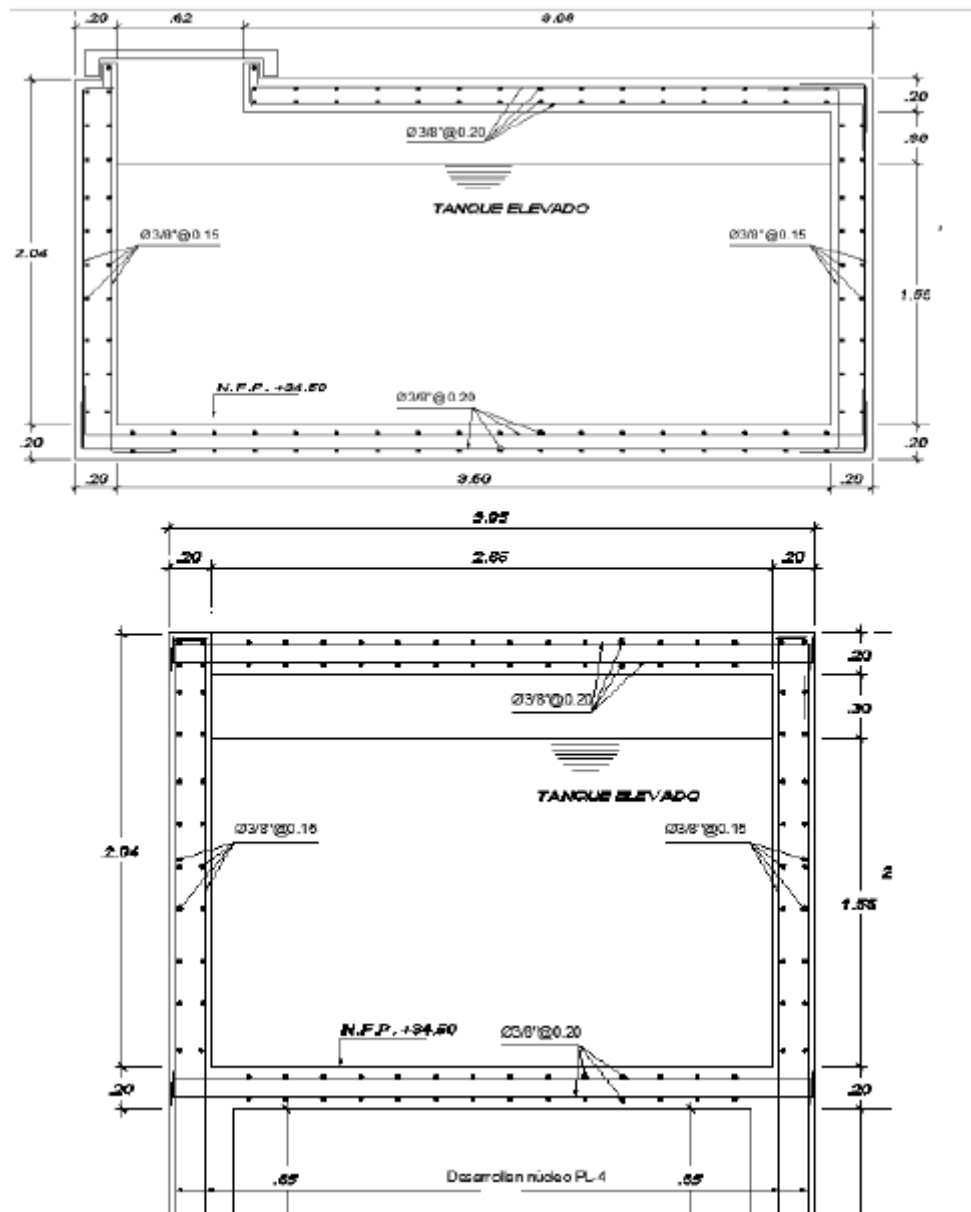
Detalle del refuerzo en el tanque elevado Icr
